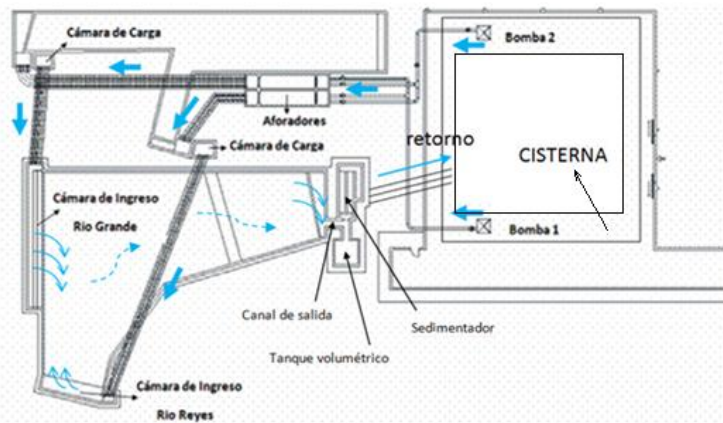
Planta esquemática de las instalaciones del Laboratorio de Hidráulica
